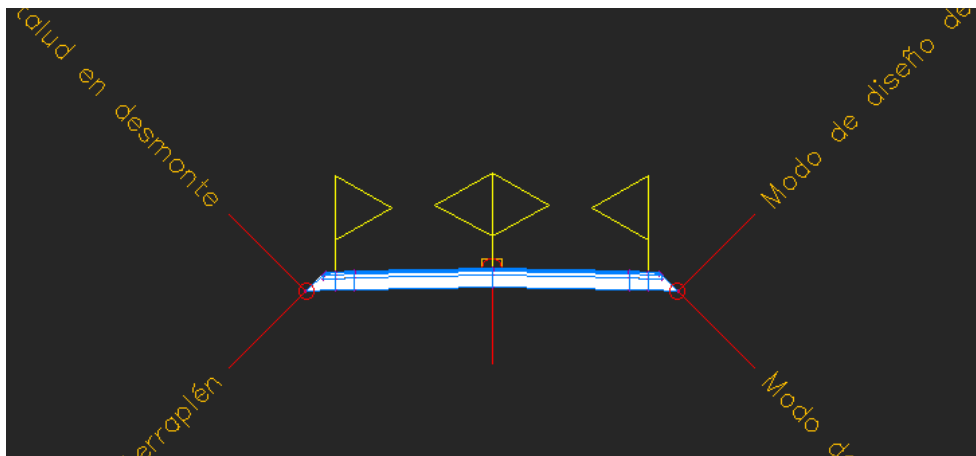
Ensamblaje N-344. Fuente: Elaboración propia.
